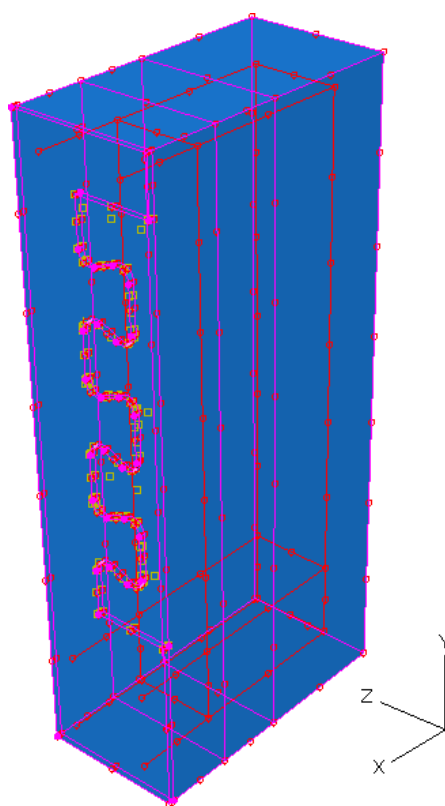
Interação entre a armadura e a laje (*Embedded Constrain*).
